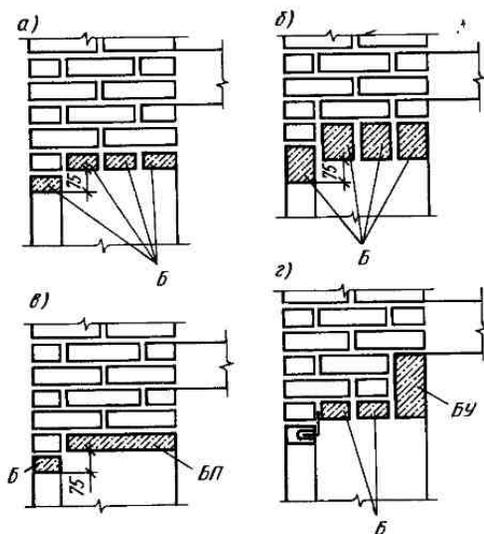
Сборные железобетонные перемышки: а, б — брусковые (тип Б), в — плитные (тип БП), г — балочные (тип БУ)
